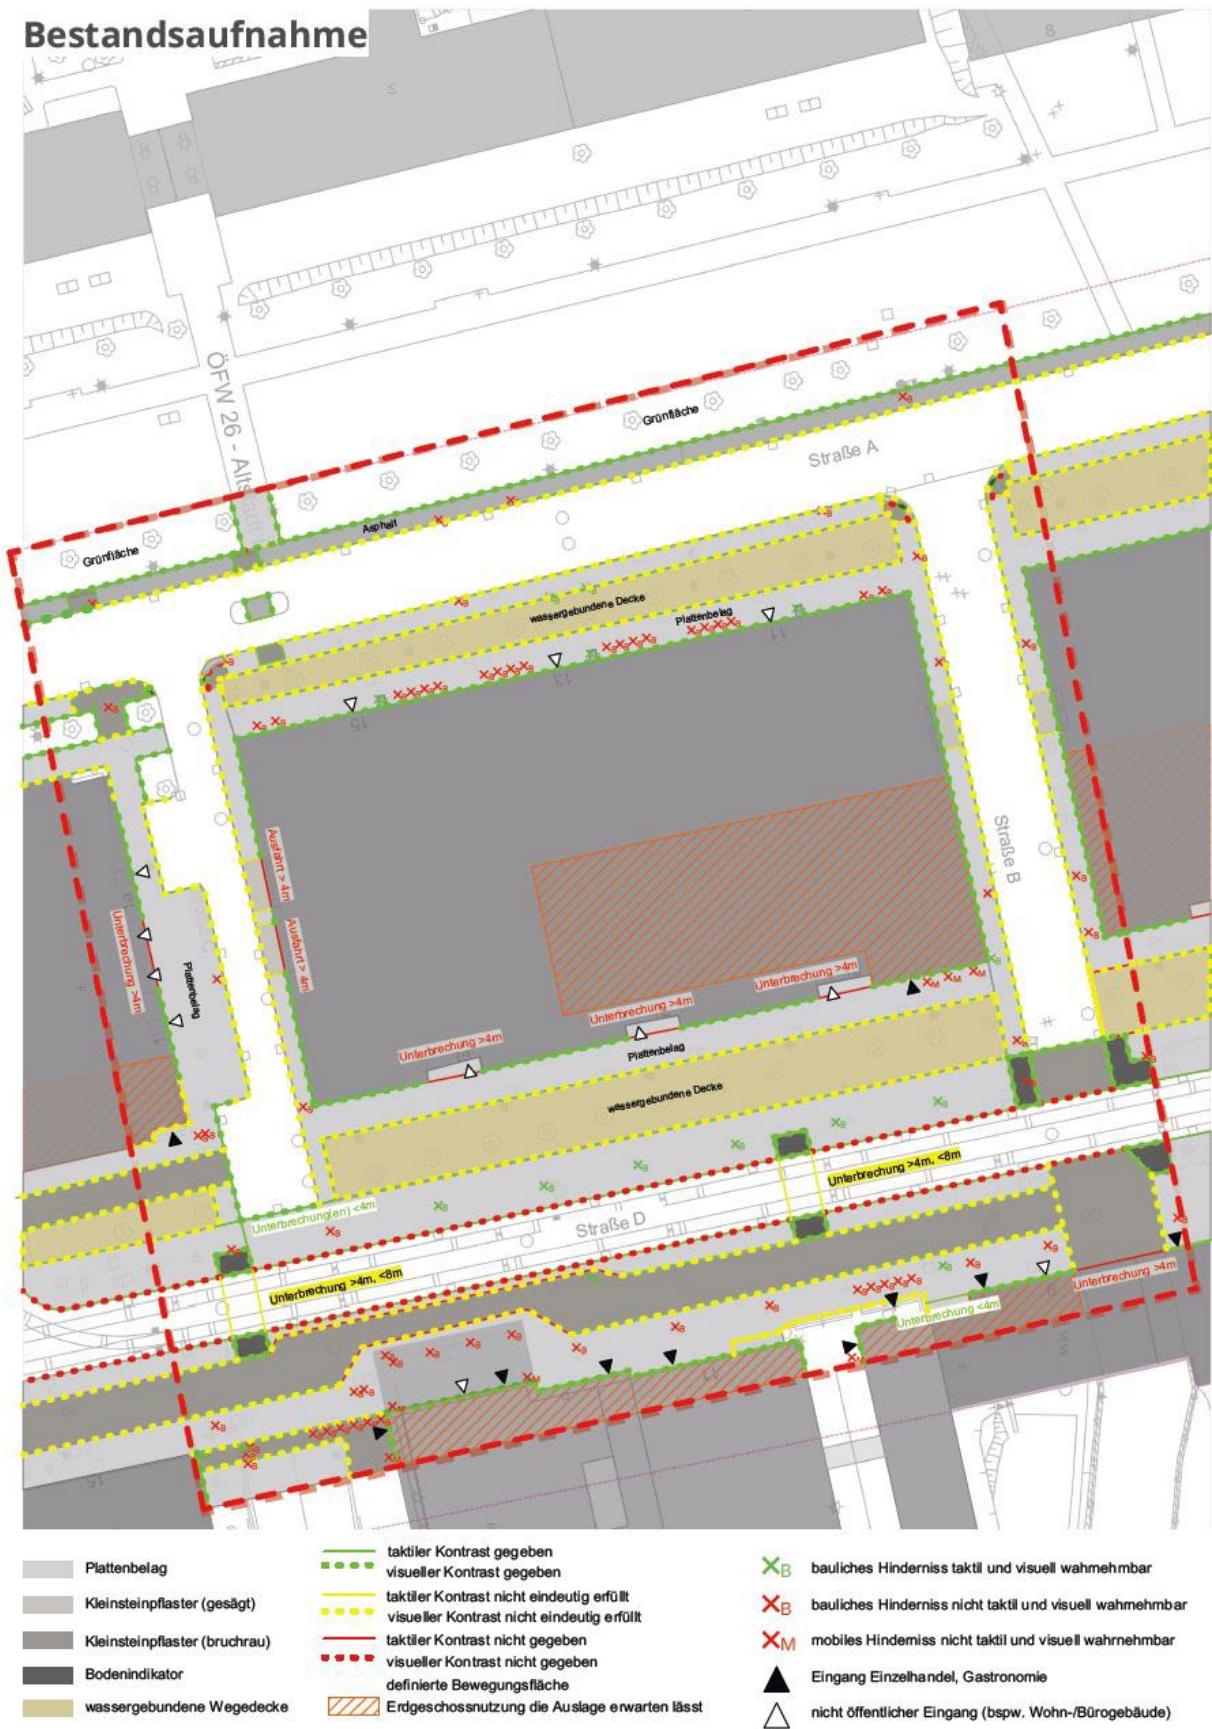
Plandarstellung der Bestandsaufnahme.
